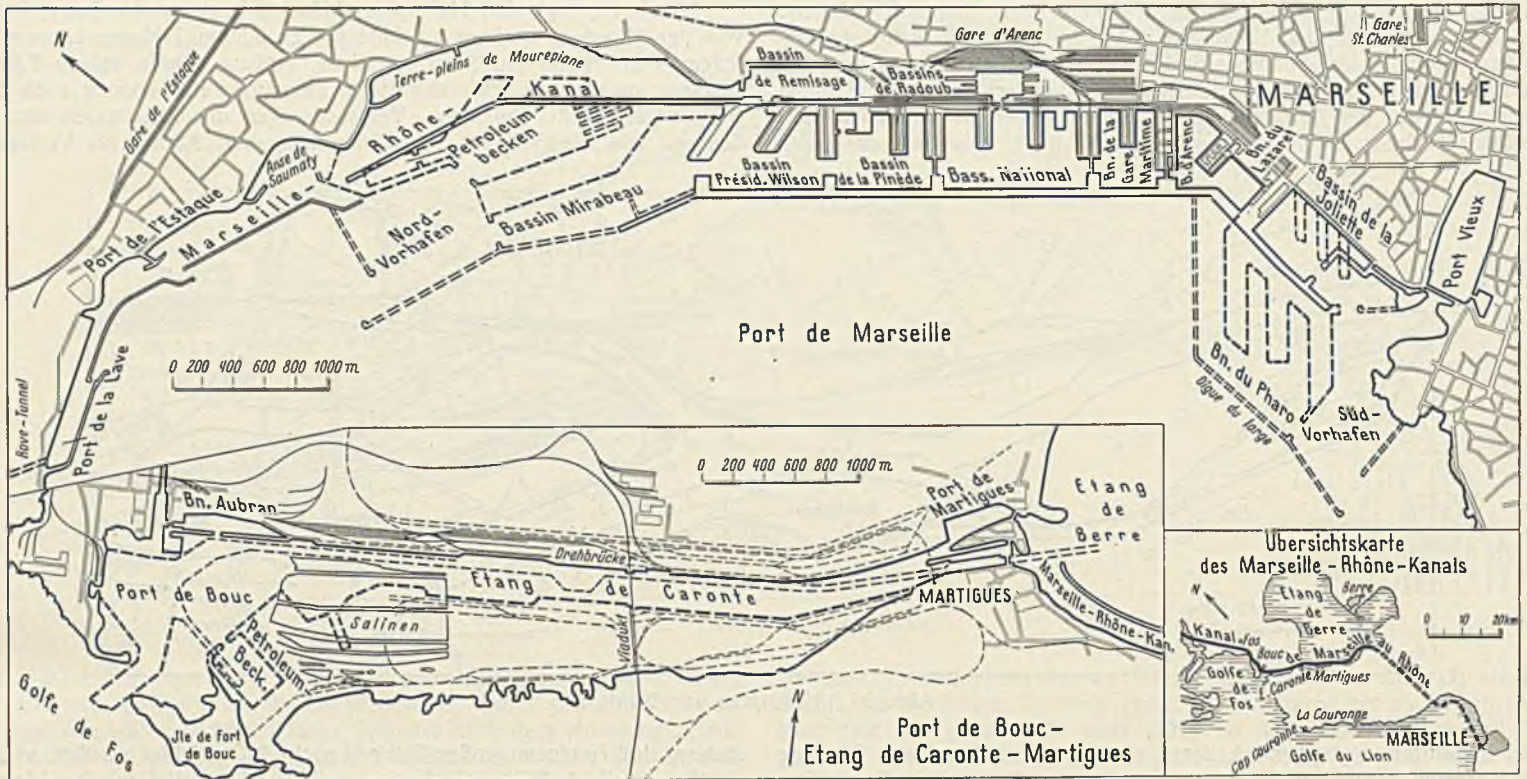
Plan des Hafens von Marseille und seiner Nebenhäfen.
